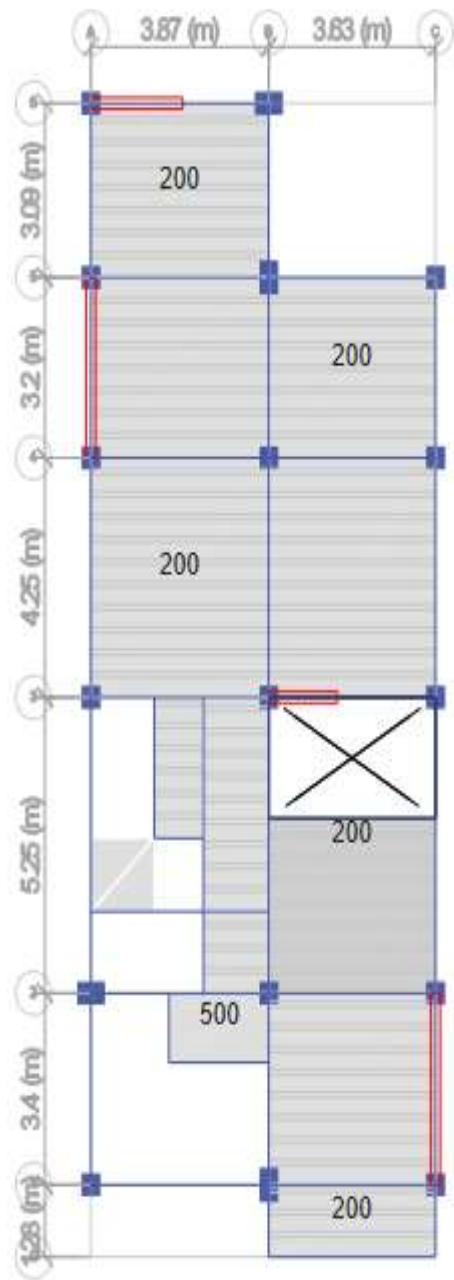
Vista de Planta Asignación de Carga viva live 01 del 1er al 3er piso
